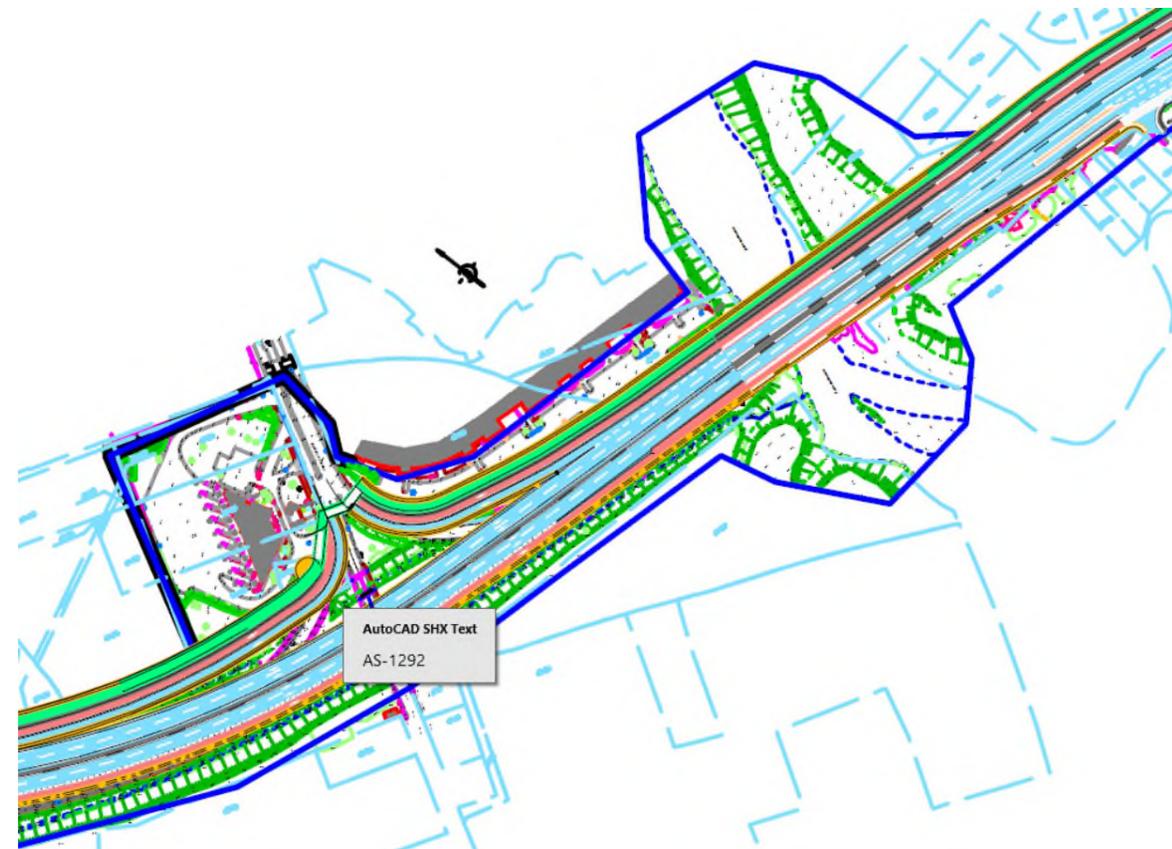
SCÉNARIO 3 : TCSP EN POSITION BILATÉRALE : PLAN GÉNÉRAL SYNOPTIQUE – ZOOM SECTION 1 : BEAULIEU – LE CONARDEL
